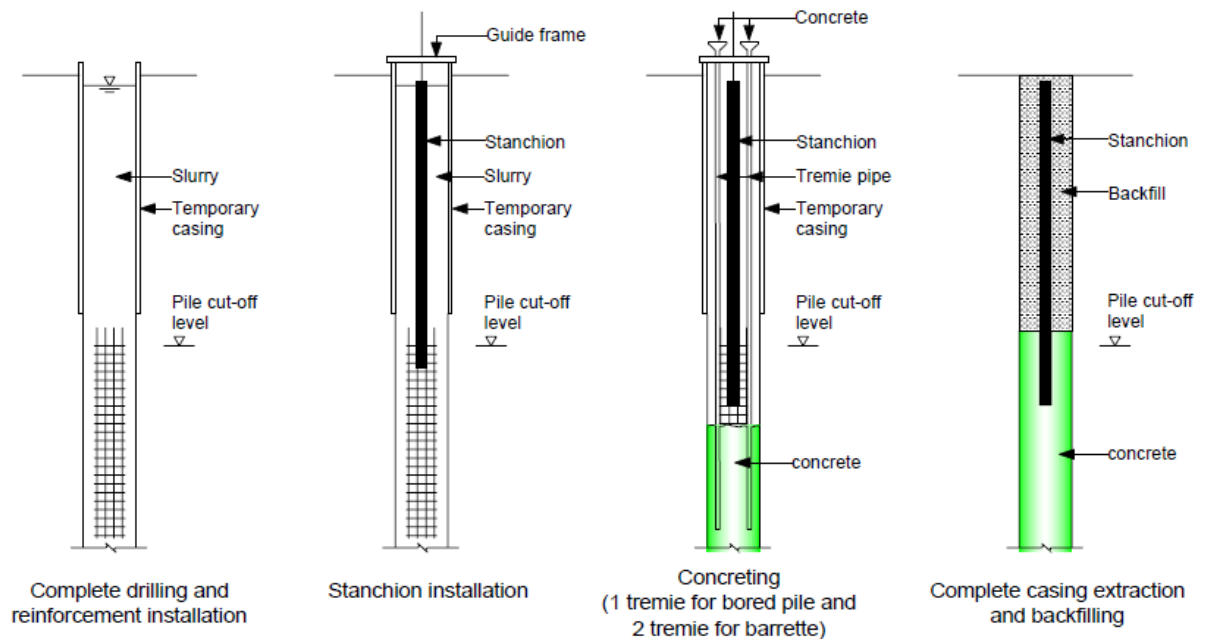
Proceso constructivo pre hormigonado. Balasubramaniam et Al. (2000)
